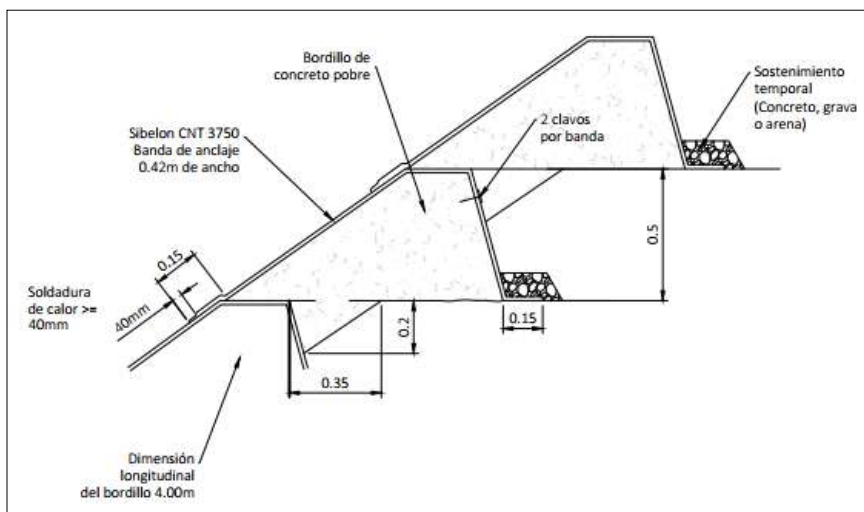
Detalle de construcción de bordillo e instalación de bandas de anclaje
